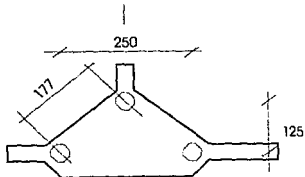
VISTA EN PLANTA DEL DADO D-3
